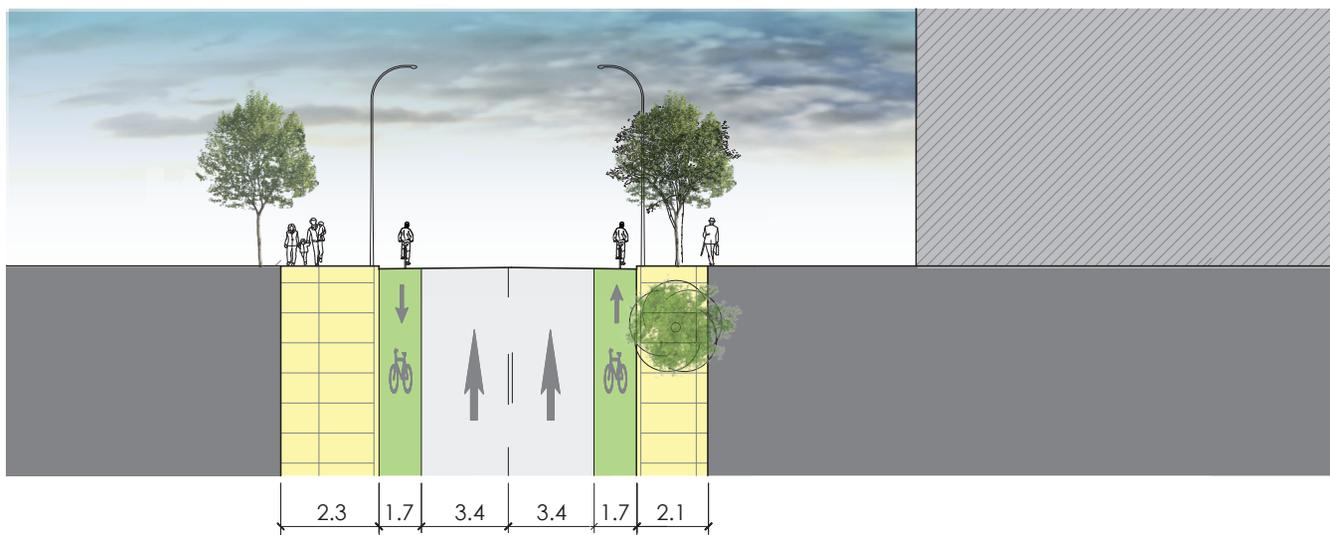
Coupe A1-A1', proposition - rue de Castelnau O entre Saint-Laurent et Clark, échelle 1:300
